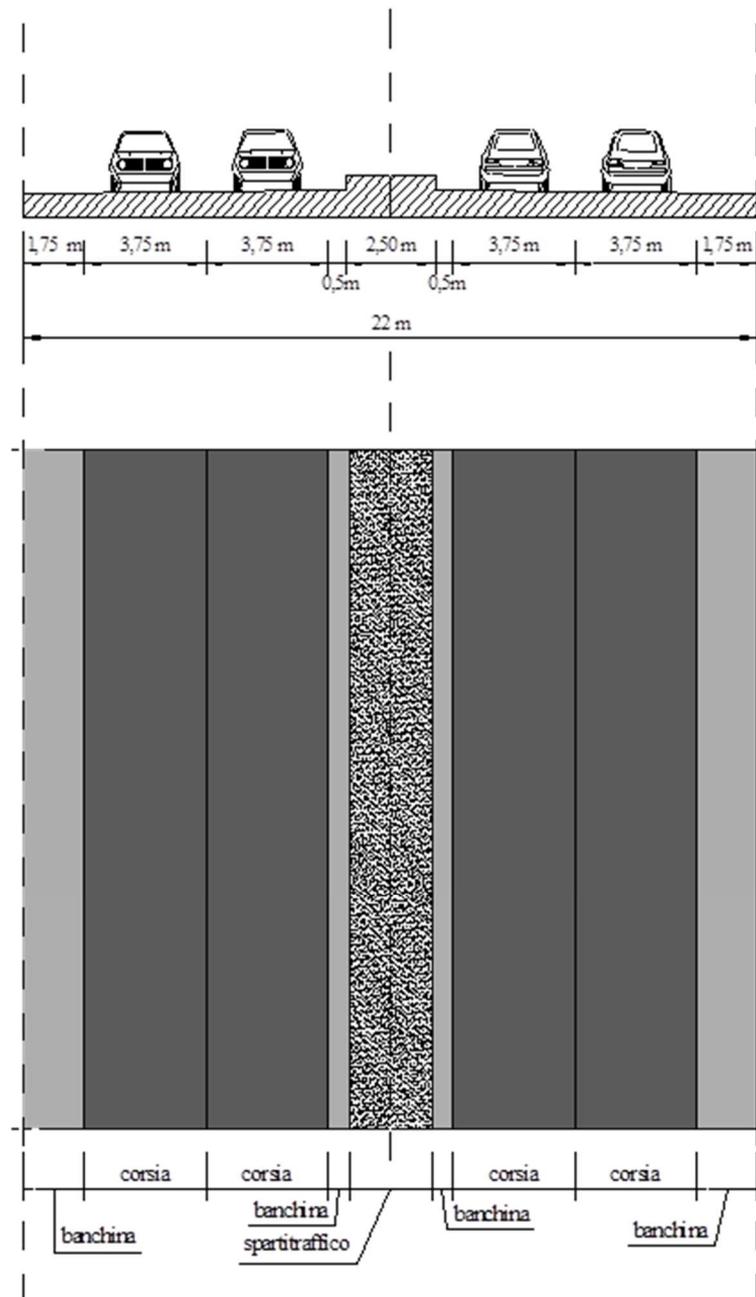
Sezione Tipo Strada Extraurbana Principale (B)
